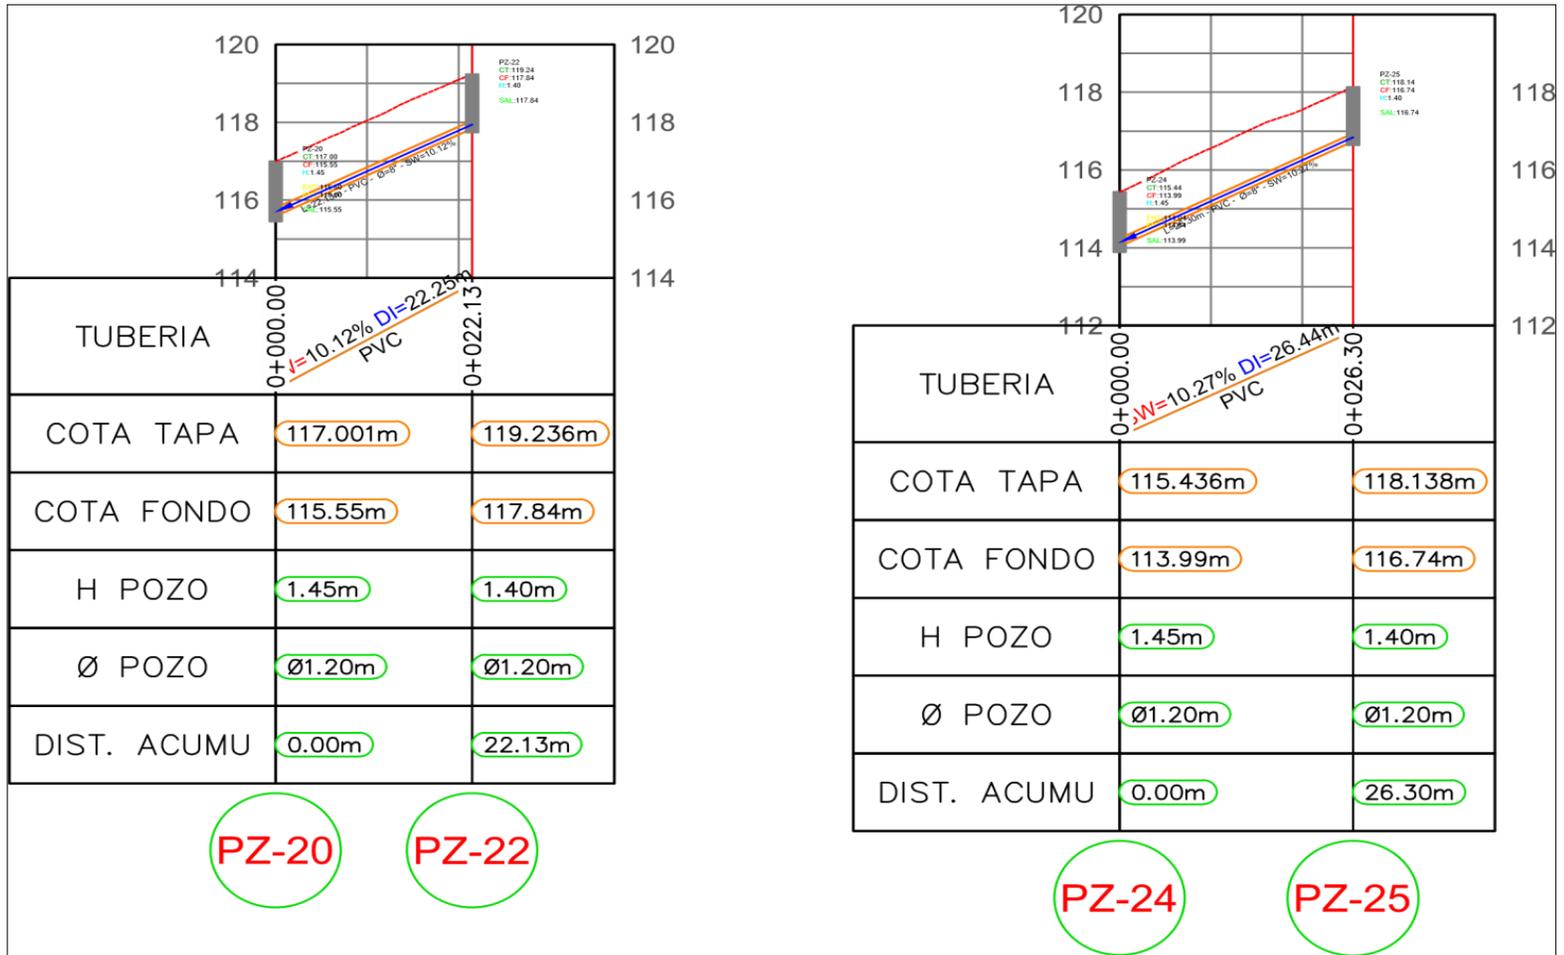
Perfil longitudinal, calle 16-3 Y 16A-2
